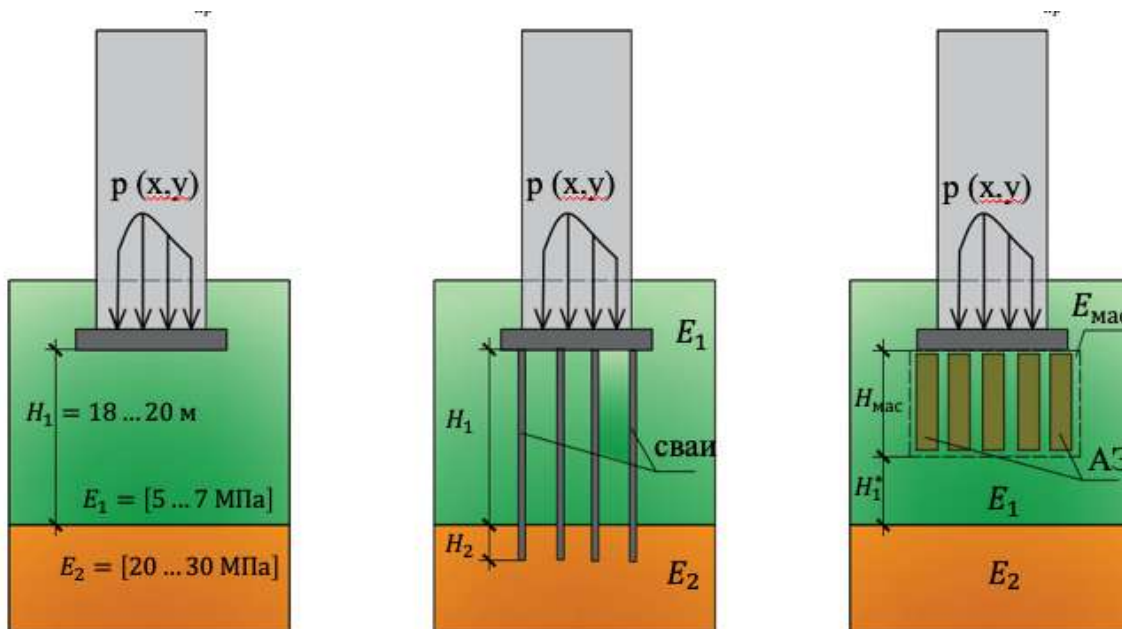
Варианты передачи нагрузки на основание: плитный фундамент; плитно-свайный фундамент; плитный фундамент на искусственном основании
